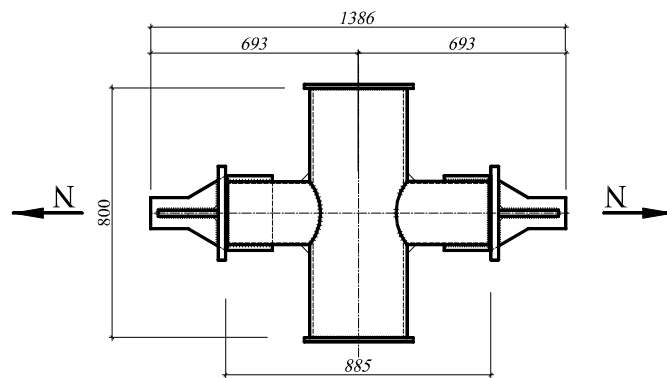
Стенд для испытания крепления подвески к затяжке.
